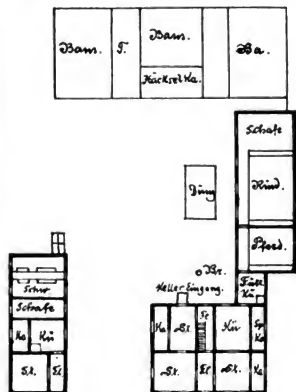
Pommersches Gehöft (Buckau), 26 ha.
